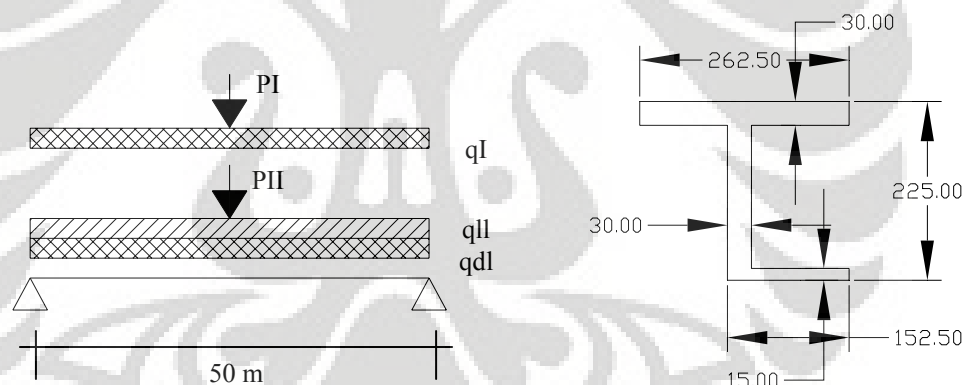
Penampang Girder Tipe I Jembatan 2 Lajur 2 Arah
